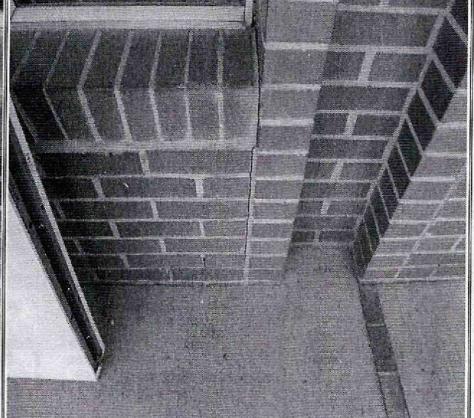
Dilatación entre los mampuestos costado norte del Jardín Infantil Atalayas, emplazado en el predio de la Calle 59 C Sur No. 89 B – 45
